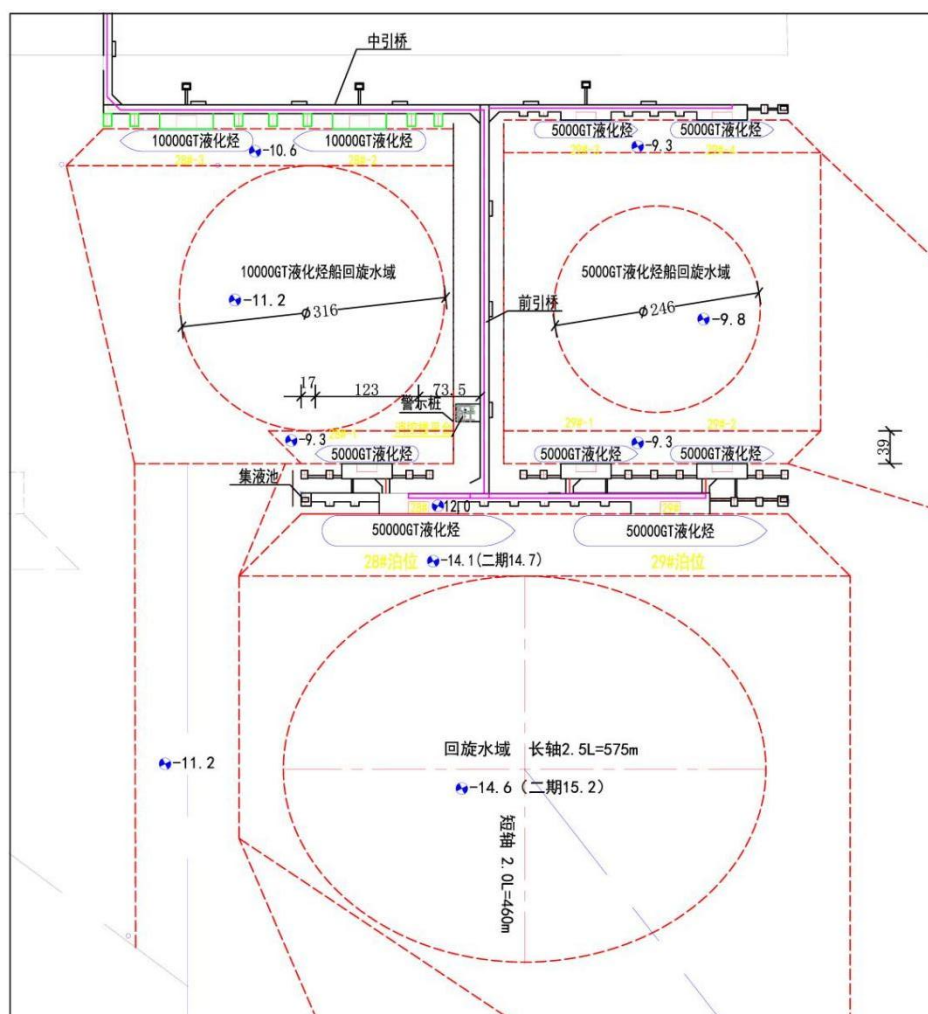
28、29#泊位工程总平面布置图（前期设计示意图）
